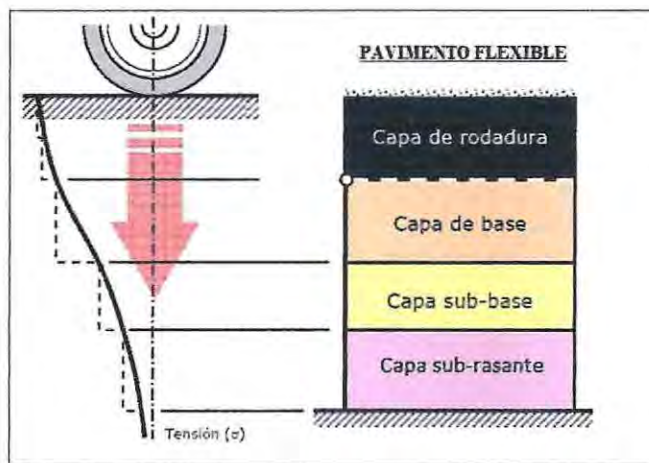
Estructuración de las capas que conforman un pavimento flexible
